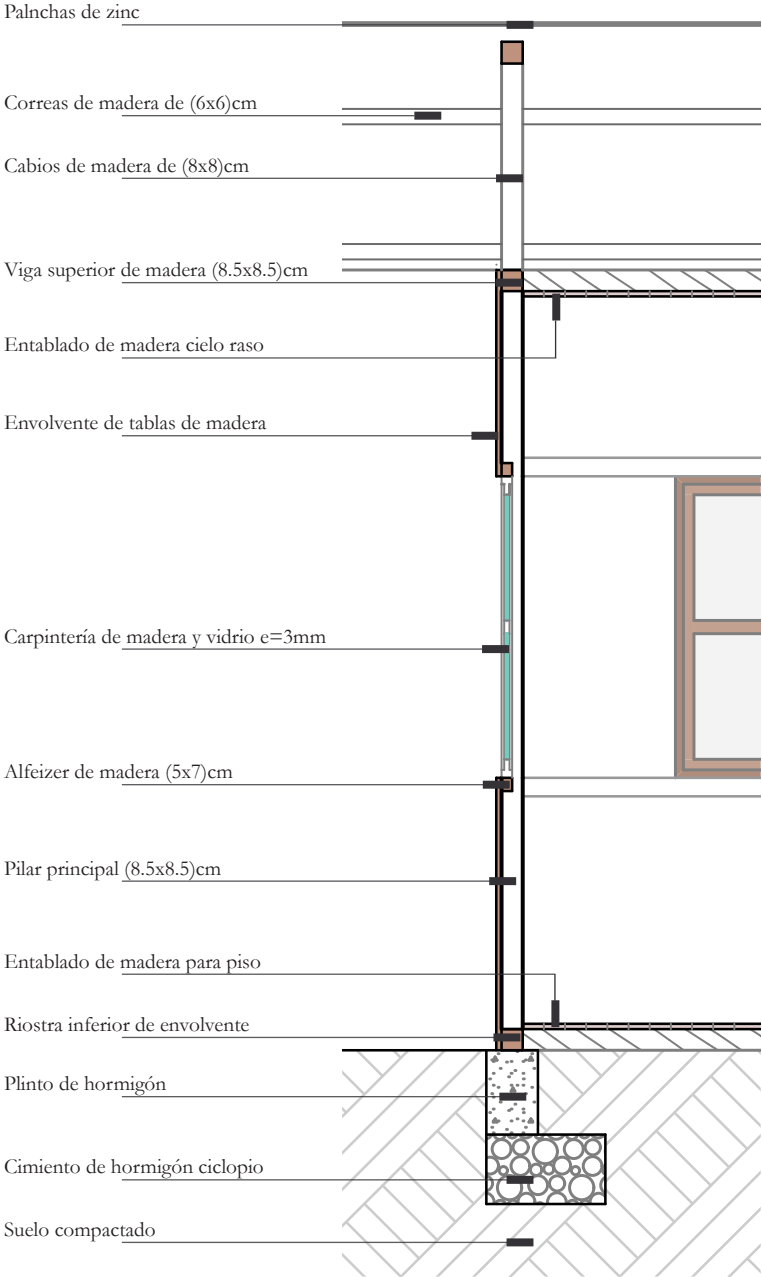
Sección constructiva de vivienda de estudio (Guzmán & Zuña, 2018)
